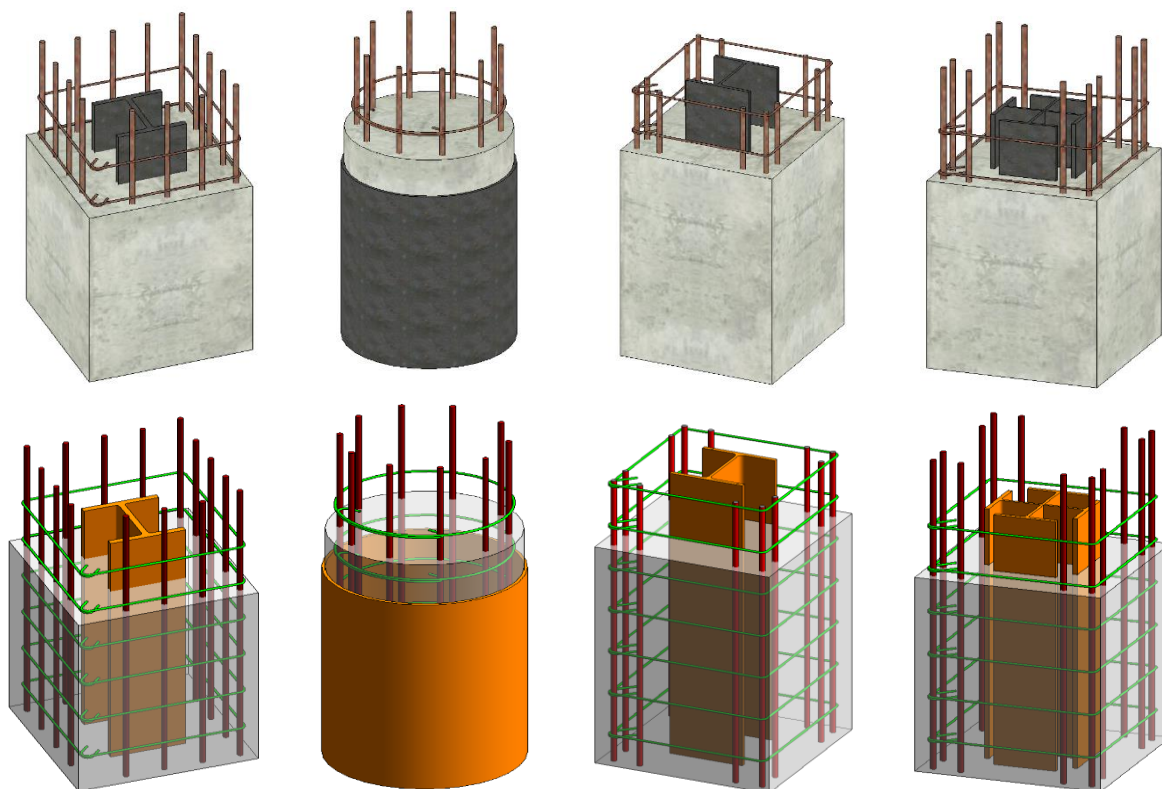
Llojet e shtyllave kompozite Beton-çelik
